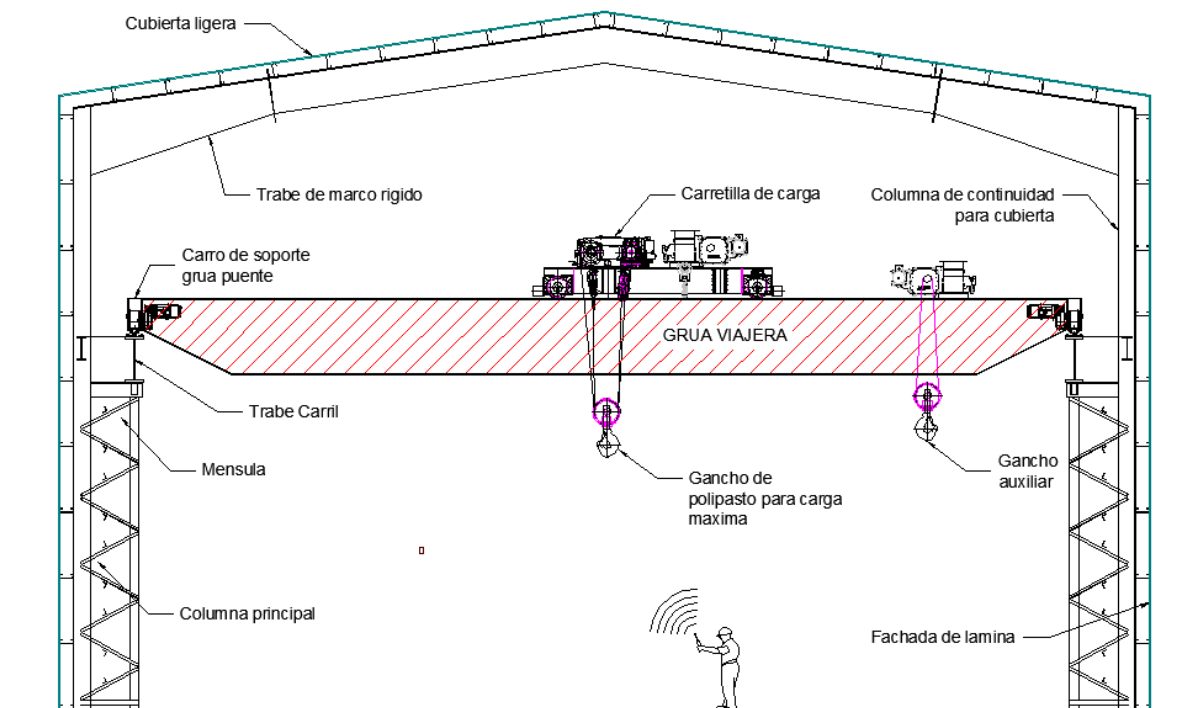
Estructura principal a base de columnas en de columnas de acero en celosía para trabe carril y trabe de acero de sección variable a dos aguas para la cubierta.
